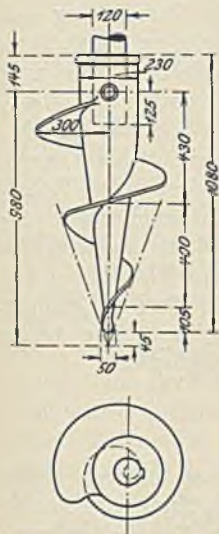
Mehrgängige, verjüngte Schraube für härtere Bodenarten.
